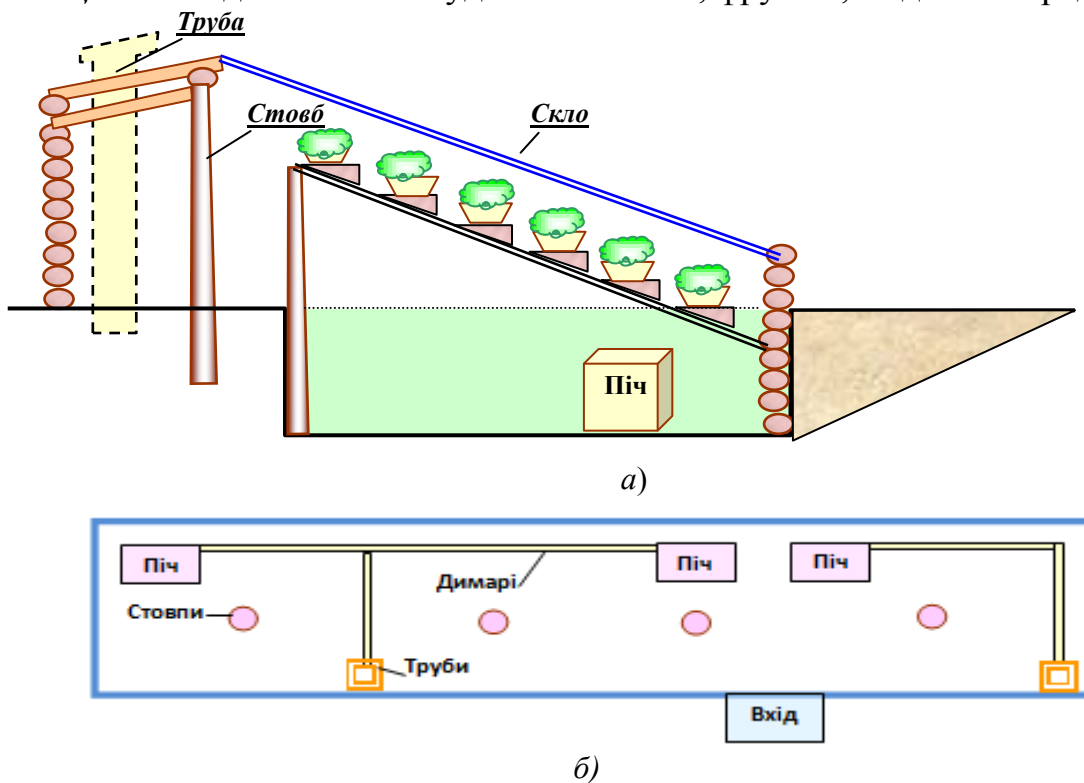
Народна теплиця 19-го ст.: а) перетин, б) план
